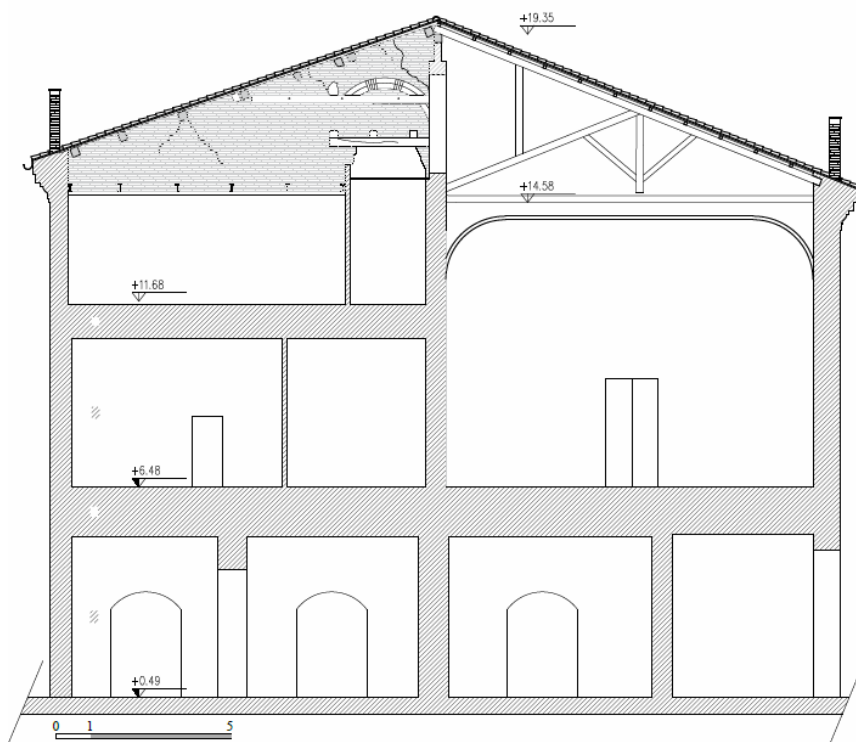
Pianta e sezione 2-2 della residenza municipale di Ravenna
